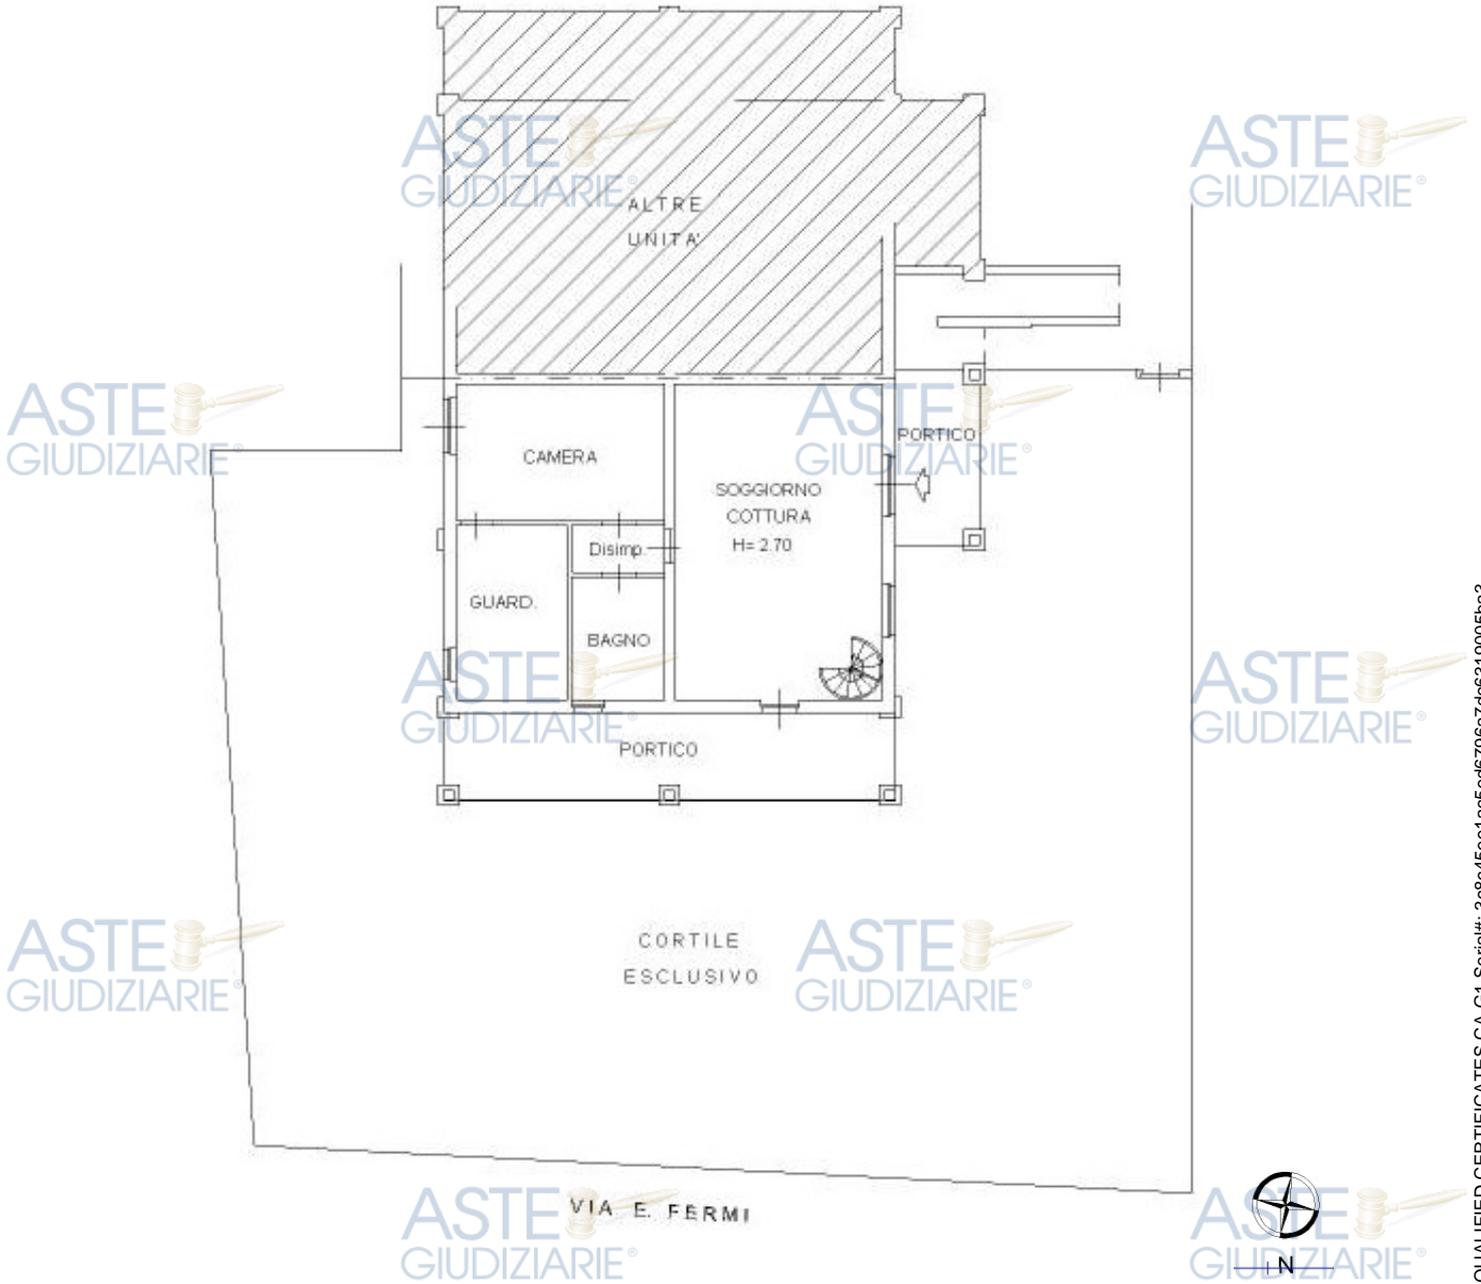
Stralcio planimetria appartamento – NCT Fg.4 particella 370 sub. 1
